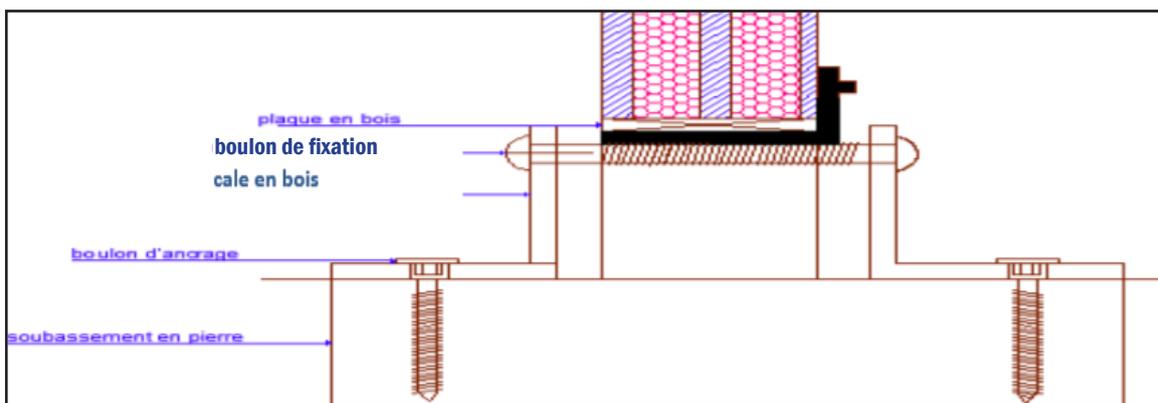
Détail fixation du panneau de vitrage au soubassement
